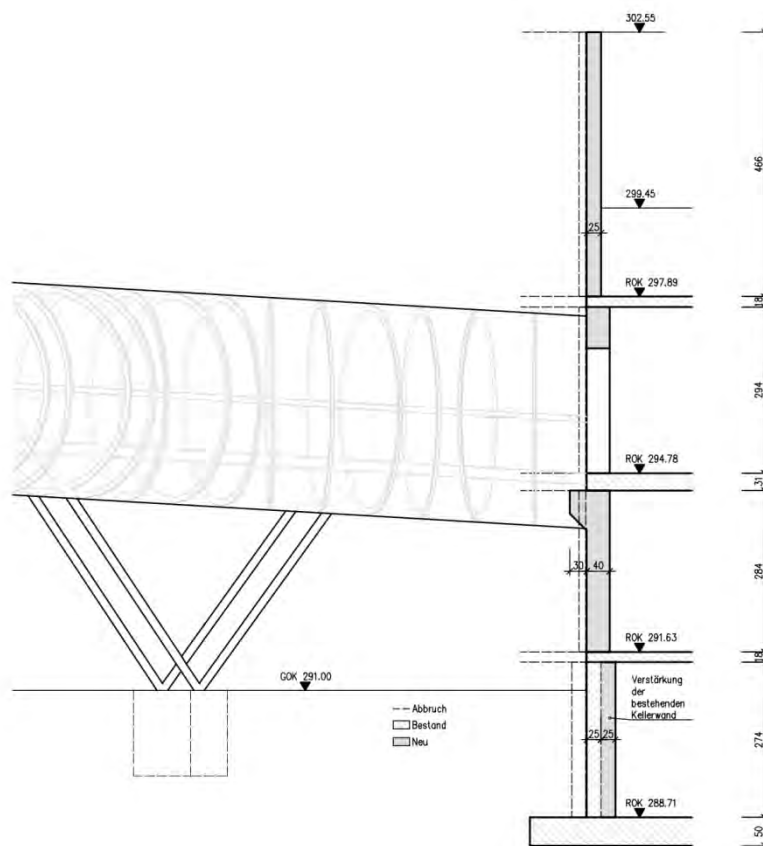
Schleusendienstgebäude – Giebelwand aus Stahlbeton
